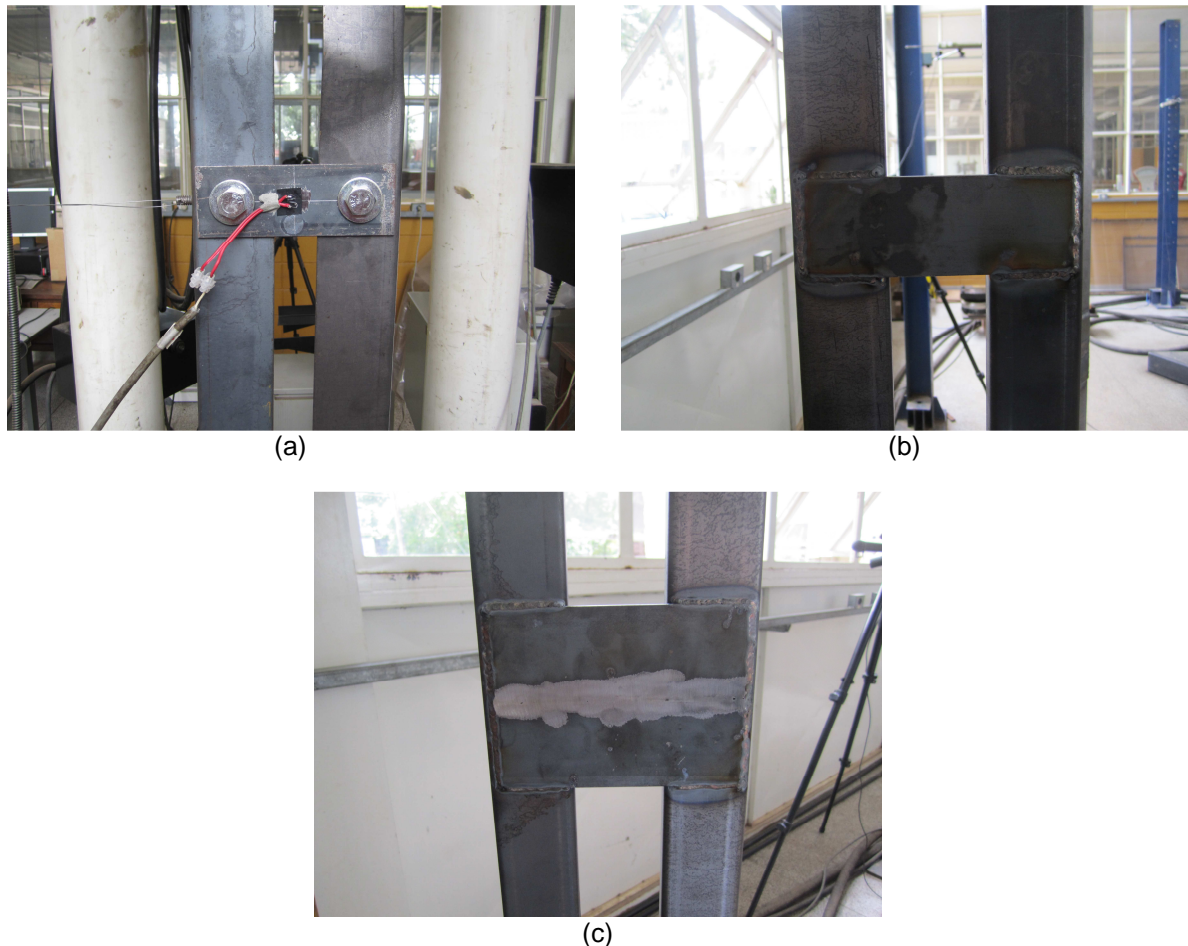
Chapas separadoras (a) parafusada; (b) e (c) soldadas
